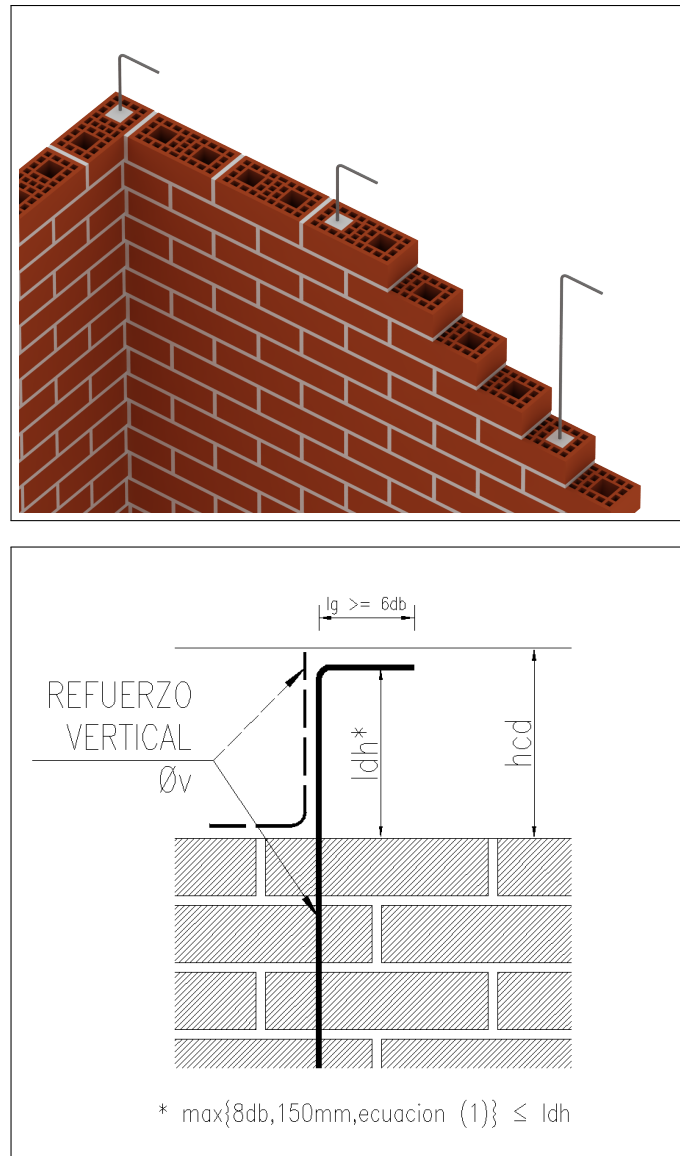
Detalle de anclaje y empalme del refuerzo vertical distribuido a lo largo del paño de albañilería.
